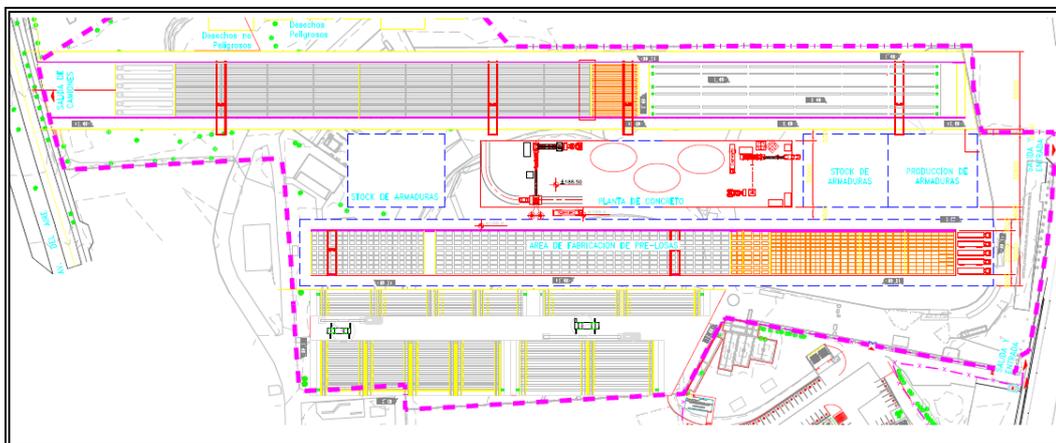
Propuesta inicial 2 de ubicación y distribución de áreas de trabajo en la planta de prefabricados del tramo 1 de la construcción del viaducto del tren eléctrico
